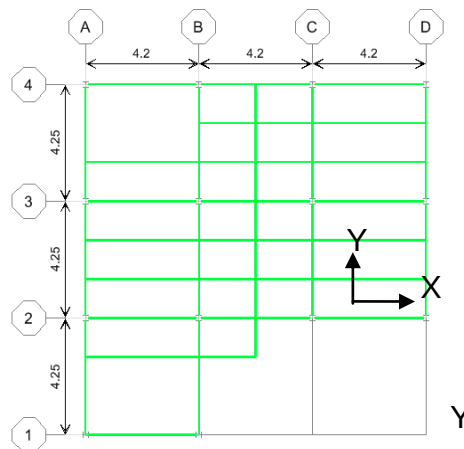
Planta tipo de la edificación "Noroeste 3"
